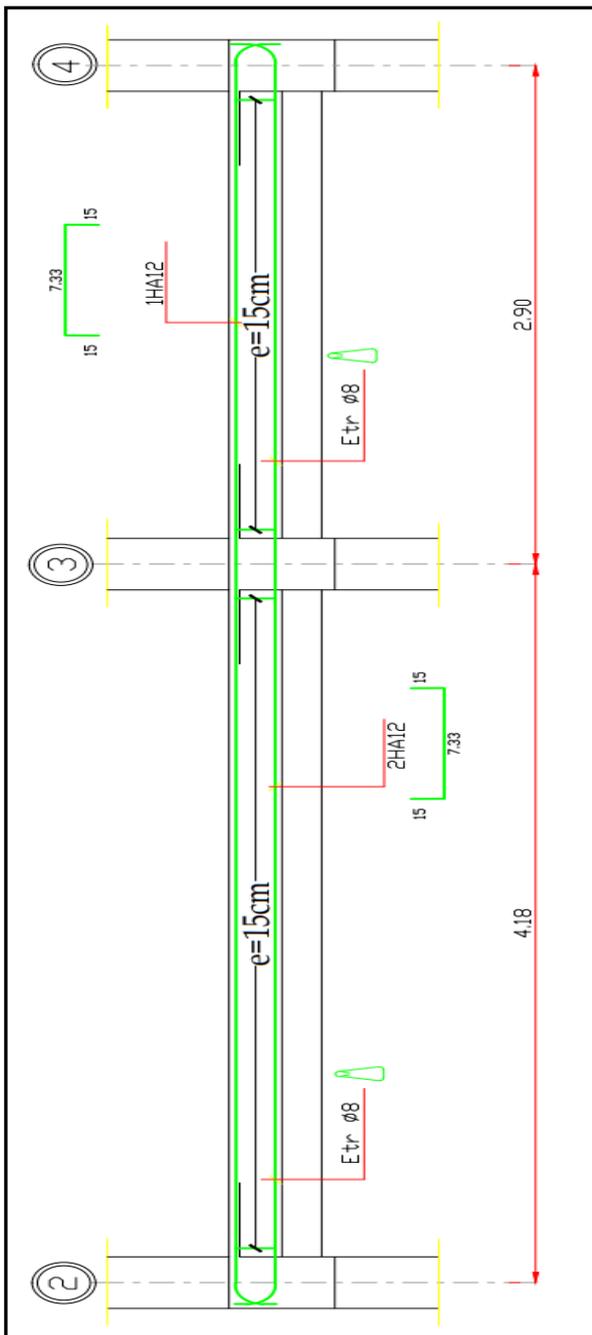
ferrailage des poutrelles d'extrémités.
